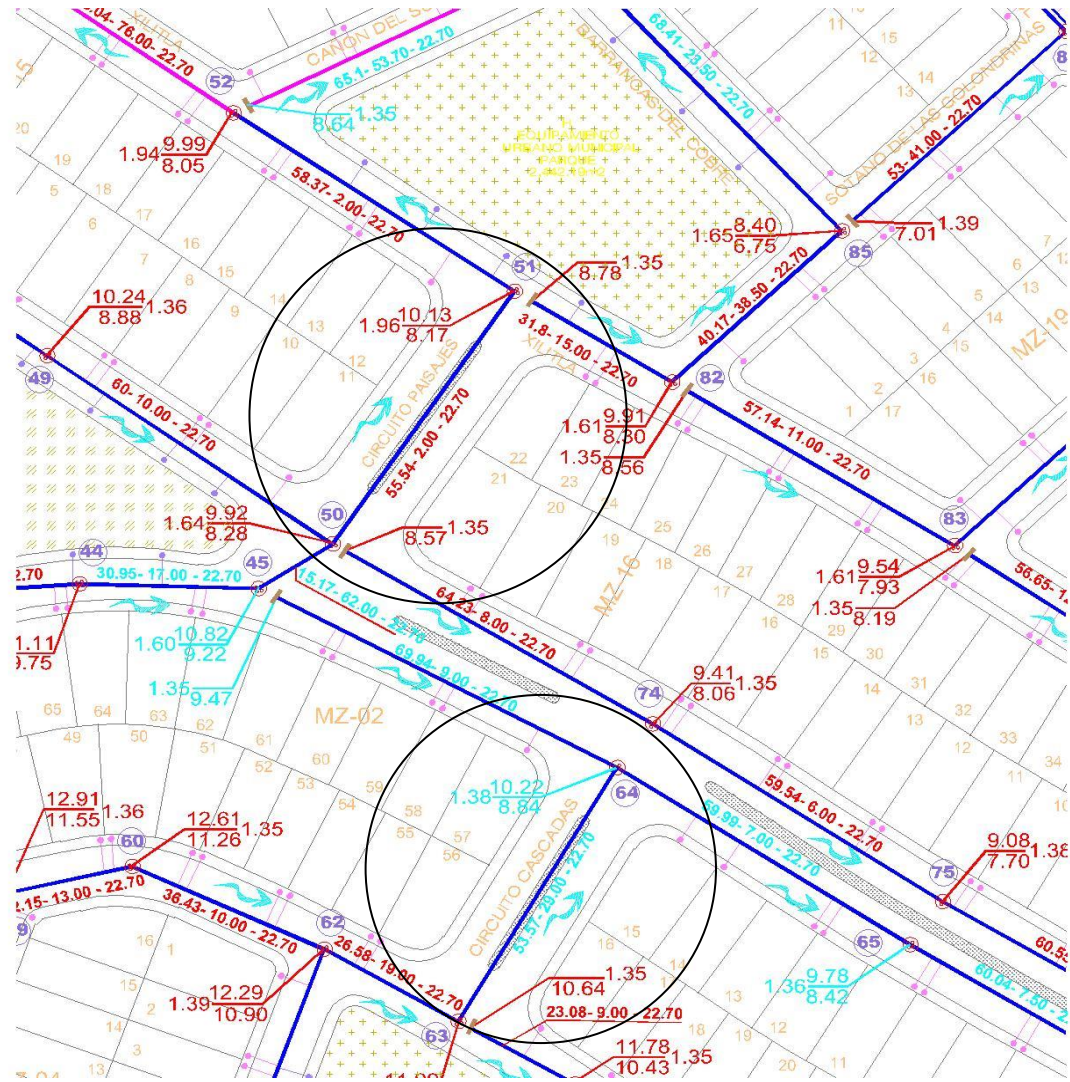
Detalle Plano original entrada a los circuitos Paisajes y Cascadas.
